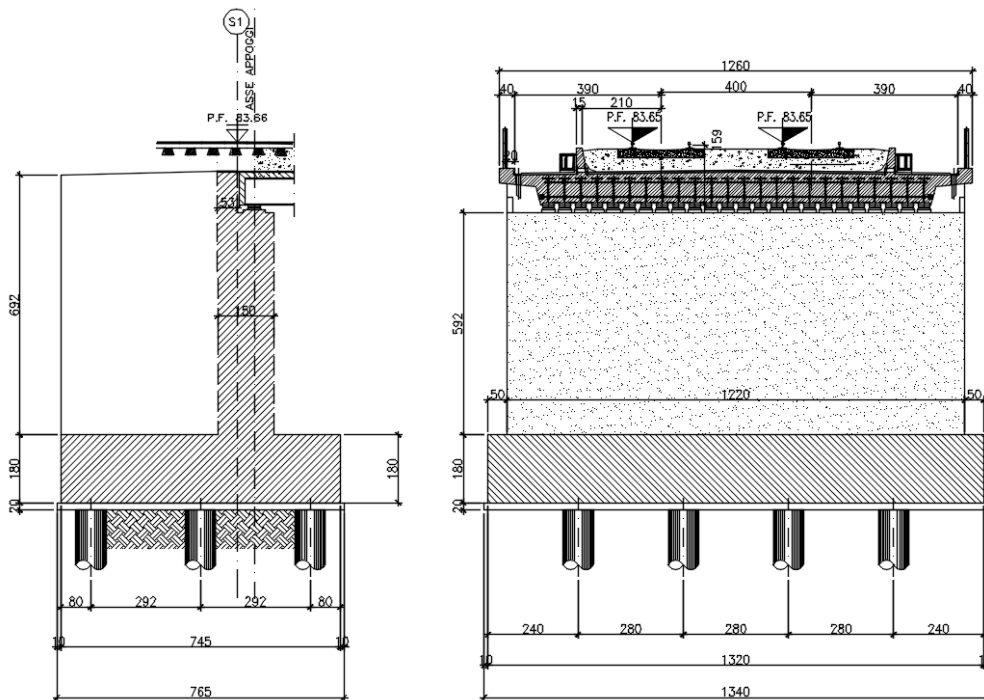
Ponte Cason Sud – Vista spalla e impalcato
